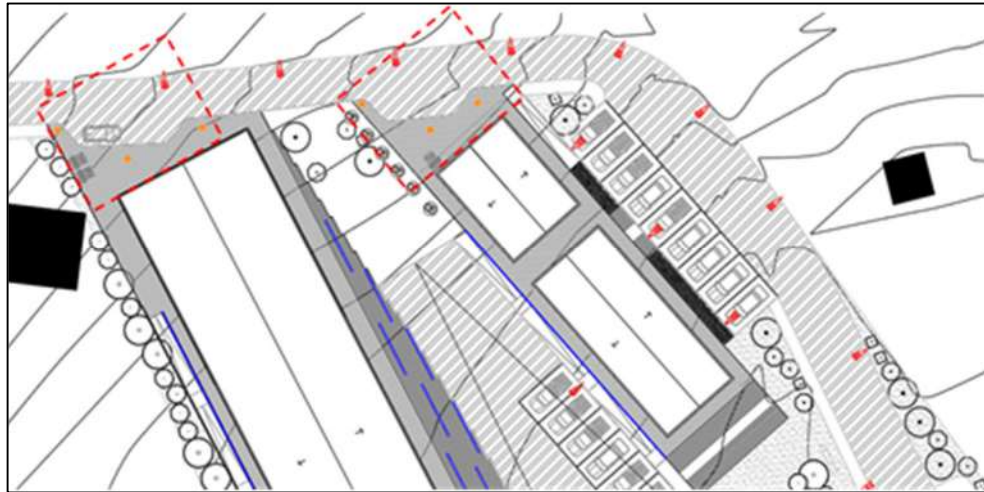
LAYOUT DE LUMINARIAS PARA ÁREAS DE ACCESO
